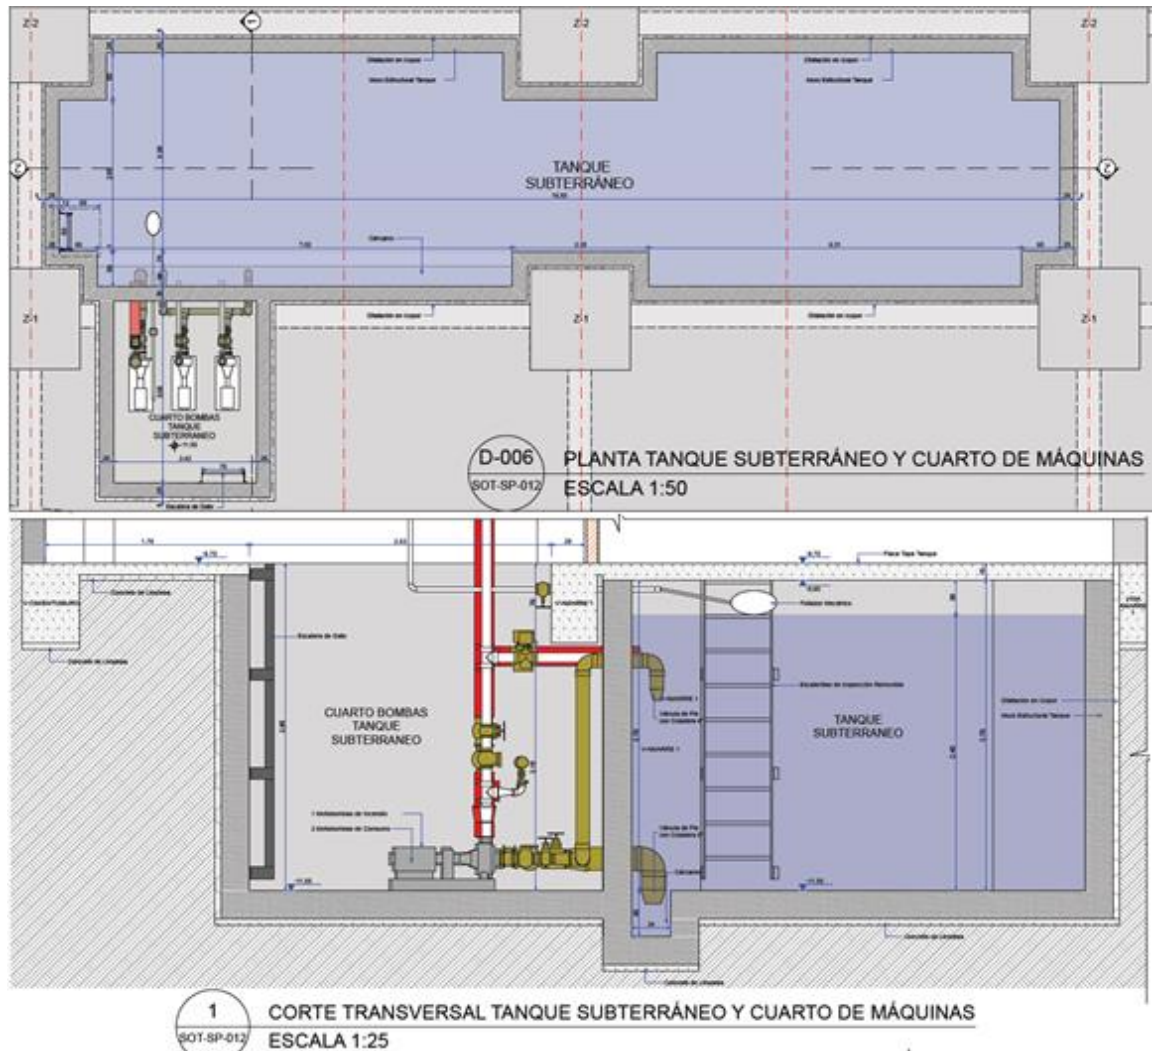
Detalle en planta y perfil del tanque subterráneo y cuarto de máquinas.
